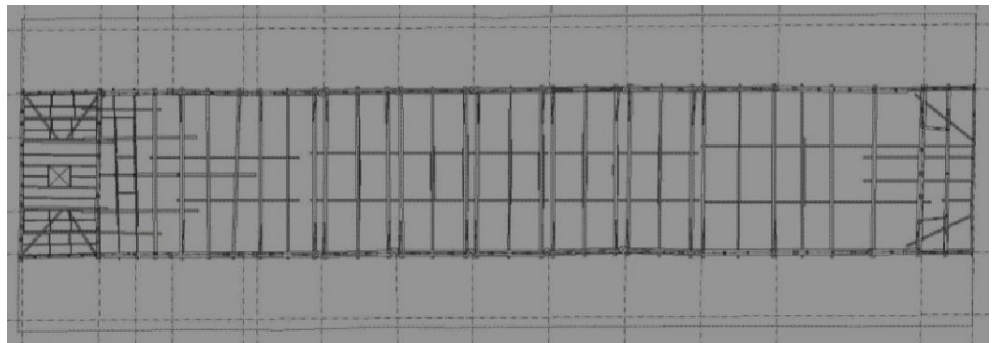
Iglesia de Achao, estructura cubierta nave central
